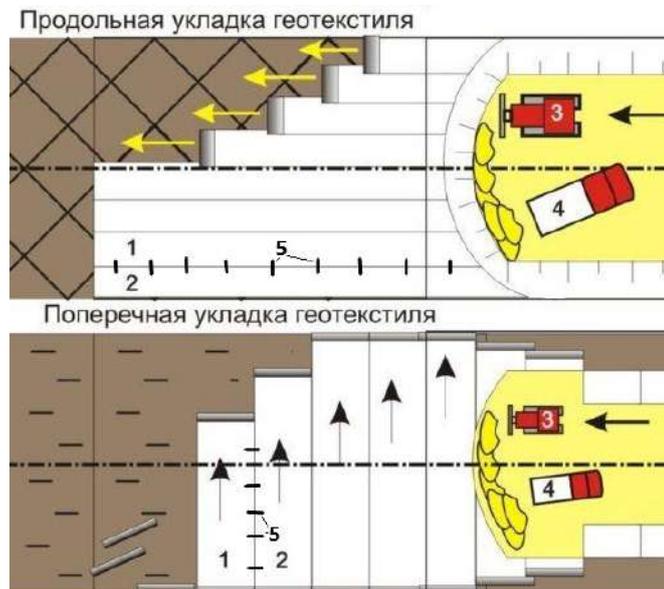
Схема укладки геотекстиля: 1,2 – рулоны геотекстиля, 3 – бульдозер, 4 – самосвал, 5 – анкеровка рулонов
